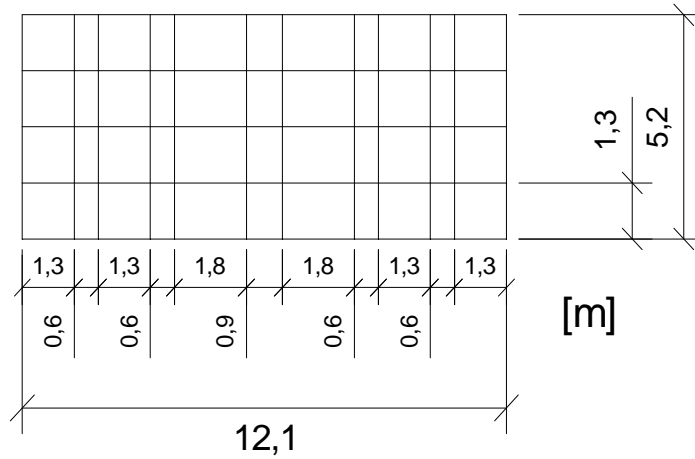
Vista Em Planta da Configuração do Cembre ao Solo Contínuo Adoptada Para Uma Secção Tipo de Um Viaduto com 40 m de Vão
